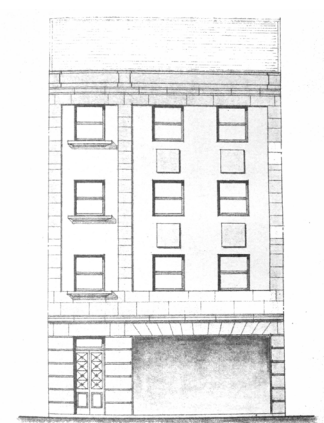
Plano del alzado frontal del edificio ubicado en la Rúa Celso Rivas Pérez, 7 (fotografía de autoría propia).
